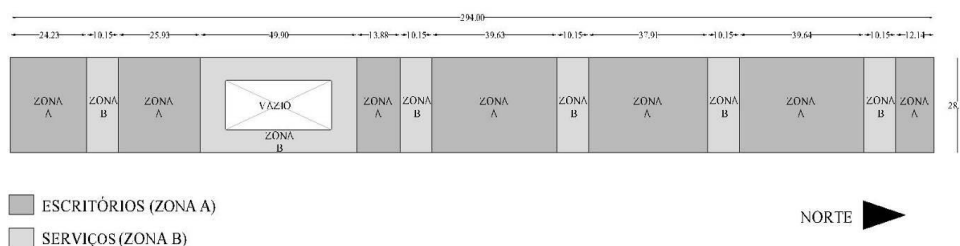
Modelo de estudo – Pavimento tipo. Fonte: elaborado pelos autores.
